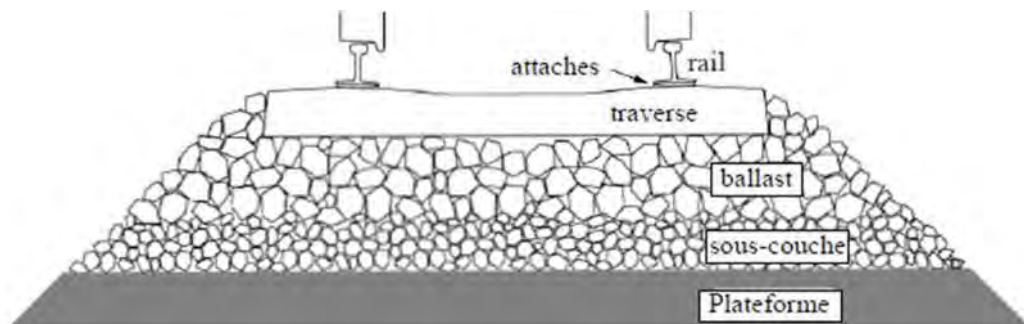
Coupe d'une voie ferrée (Quezada, 2014)
